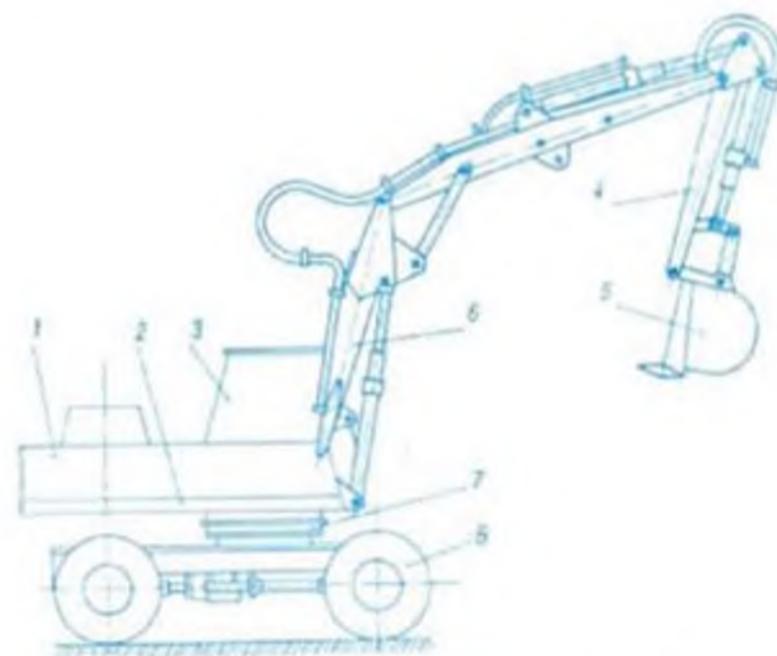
Одноковшовый экскаватор ЭО-3523А: 1 — двигатель; 2 — поворотная платформа; 3 — кабина машиниста; 4 — рукоятки; 5 — ковш; 6 — стрела; 7 — опорно-поворотное устройство; 8 — пневмоколёсный ход.
